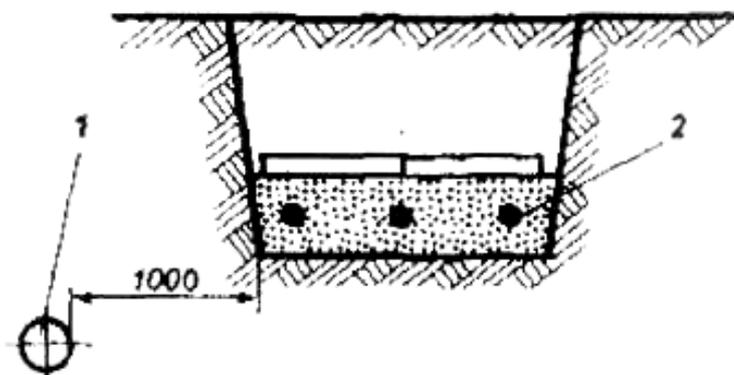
Прокладка кабелей параллельно трубопроводам, водопроводам, канализации, дренажу, газопроводам низкого и среднего давления: 1 – трубопровод; 2 – кабель 1...10 кВ
